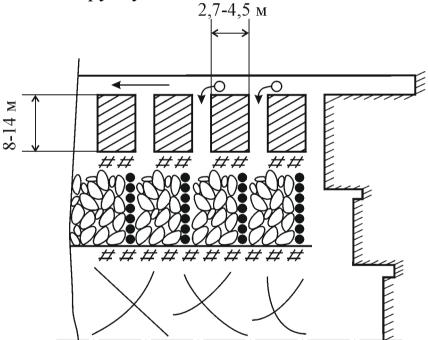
Охрана пластового вентиляционного штрека целиками угля.
